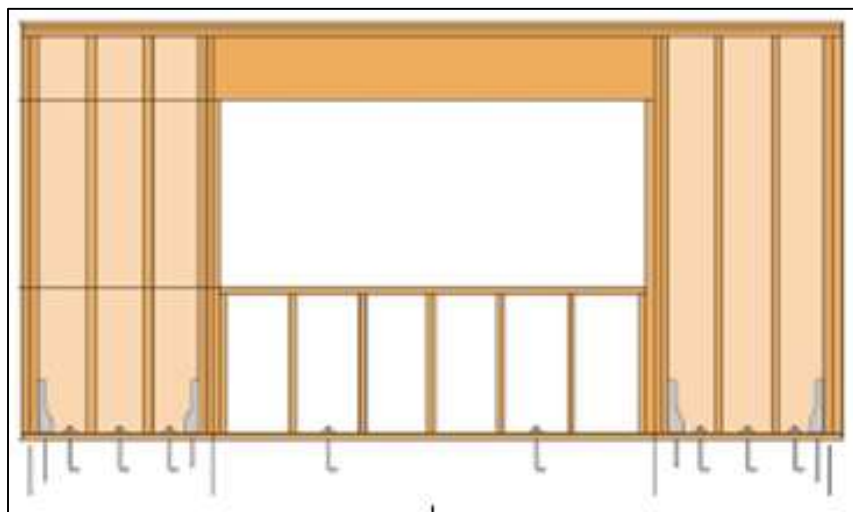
Muro de corte de madera segmentado. Fuente: (WoodWorks - Wood Product Council, 2016)
